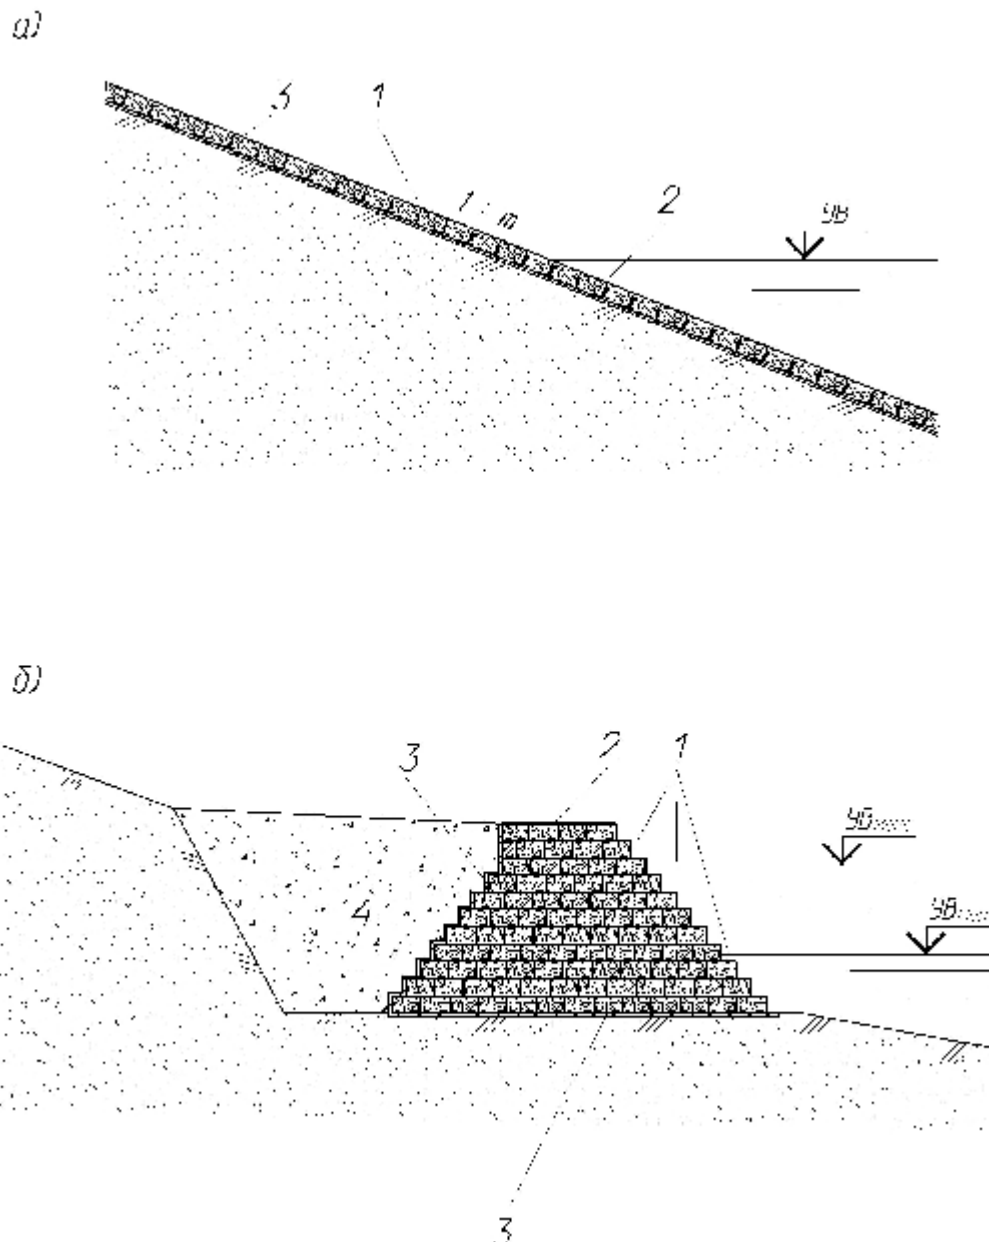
Схемы крепления грунтовых откосов гидротехнических сооружений ячеистыми полиэтиленовыми панелями с дисперсными заполнителями:
